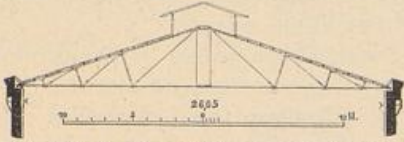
Dachkonstruktion eines Gasbehälter-Gebäudes der städtischen Gasanstalt in der Gitschiner Str. No. 48. Erbaut 1860.
